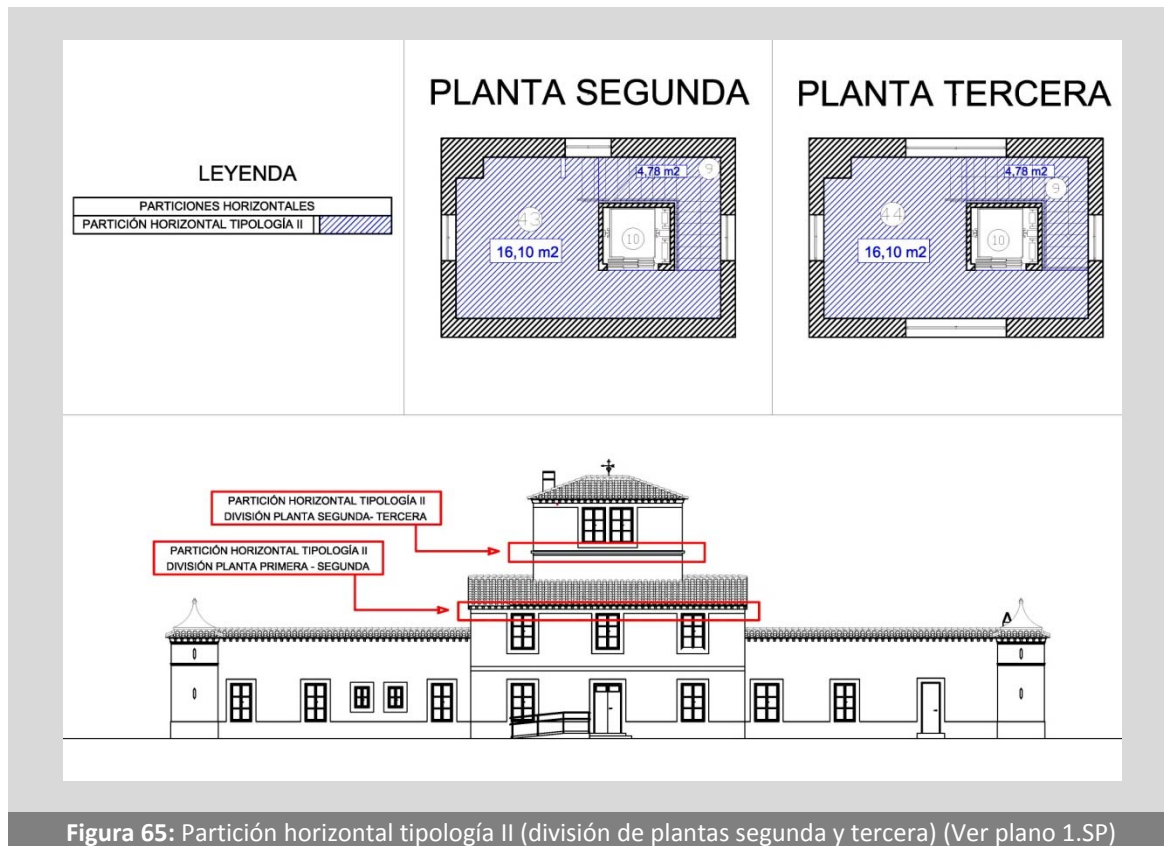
Partición horizontal tipología II (división de plantas segunda y tercera) (Ver plano 1.SP)
